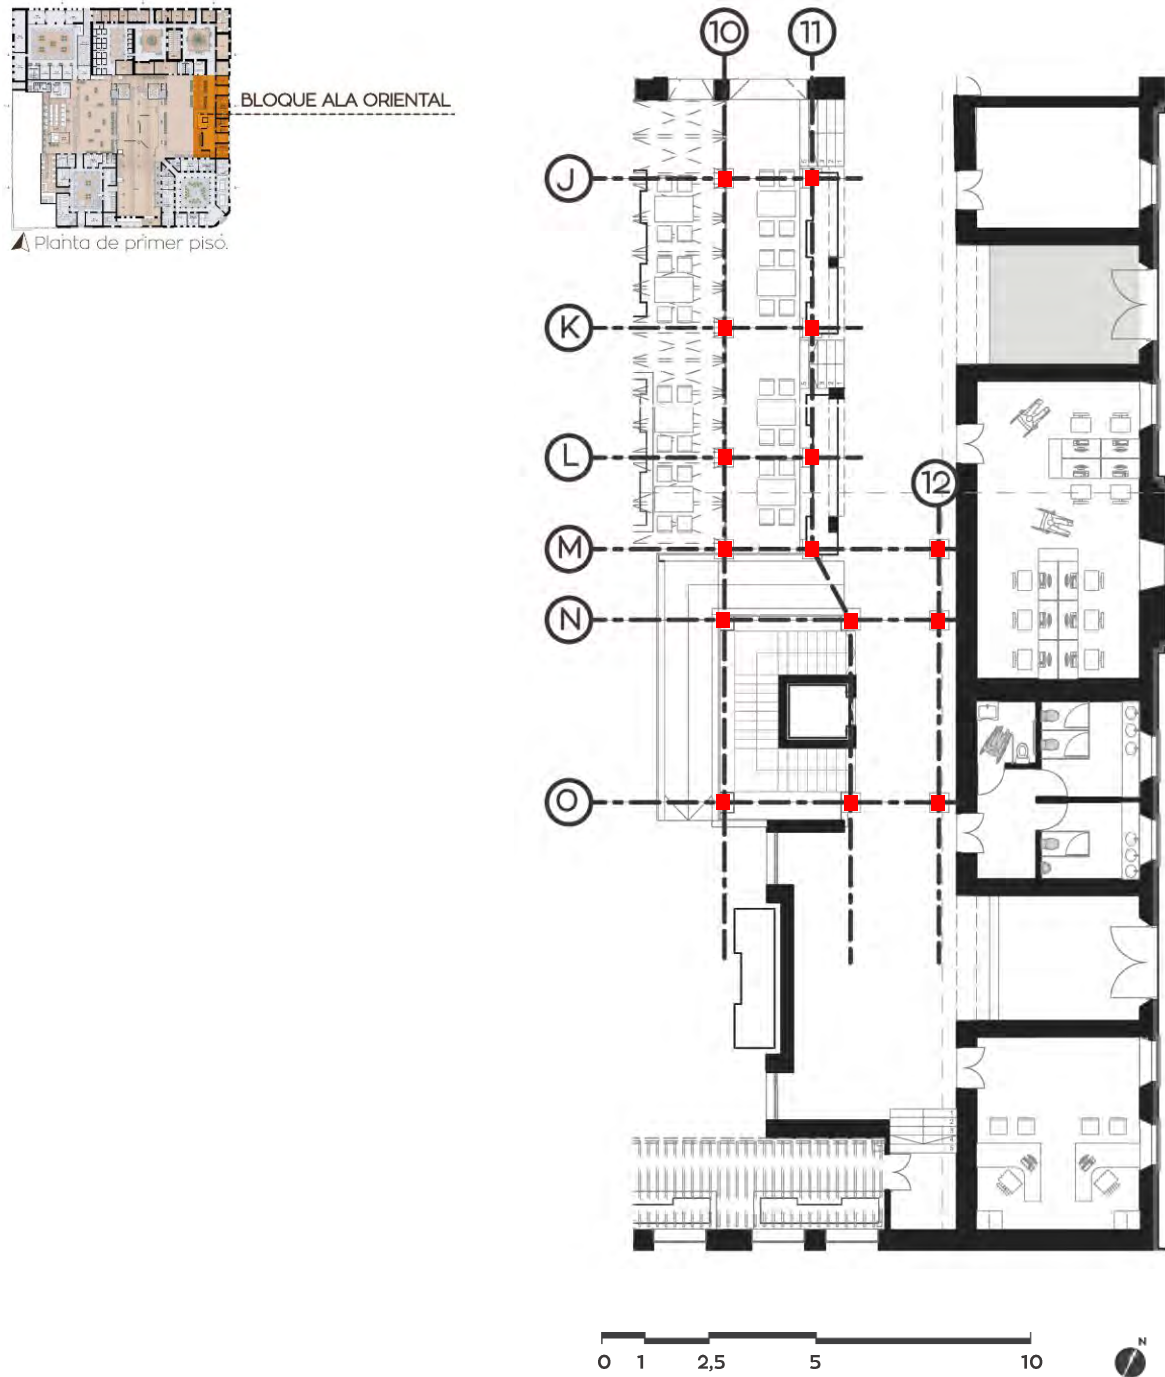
Propuesta estructural bloque C. Fuente: Elaboración Propia.
